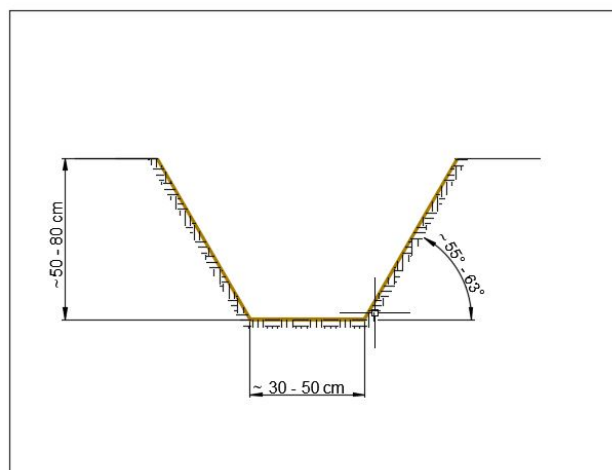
schema del progetto di piana inondabile per la laminazione delle piene
